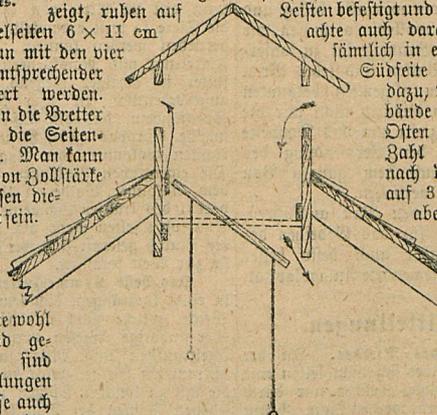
Einfacher Ventilator am Dache des Hühnerstalles.
